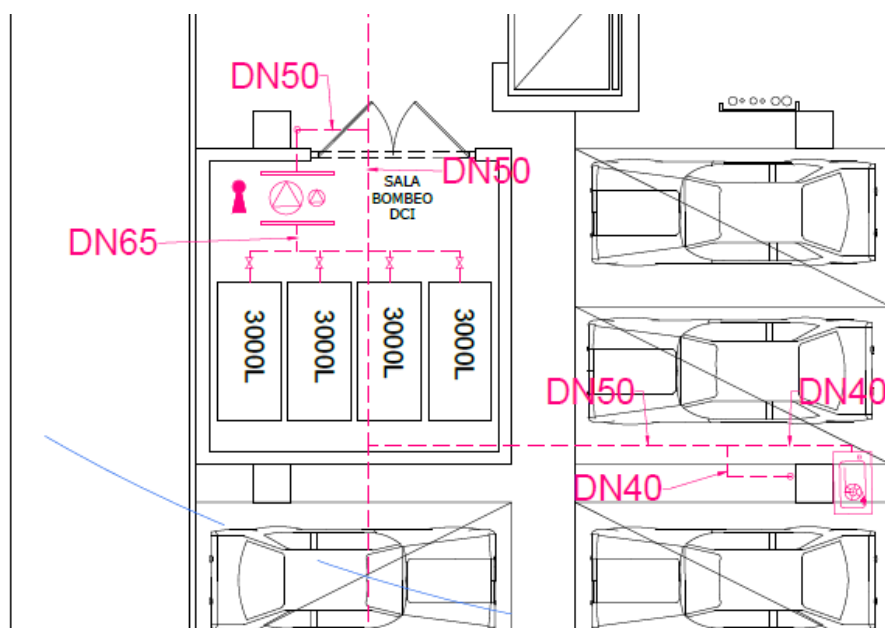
Emplazamiento cuarto bombeo PCI. Planta sótano S1. Planos del proyecto
